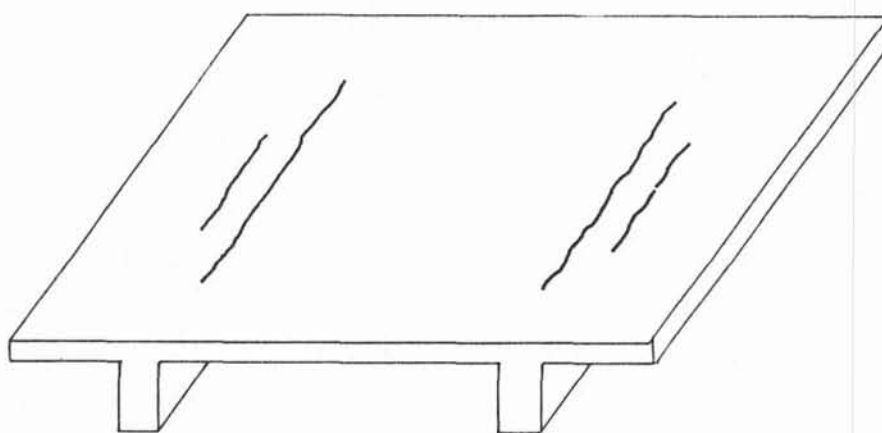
Fissuras na face superior de lajes contínuas calculadas como simplesmente apoiadas.
